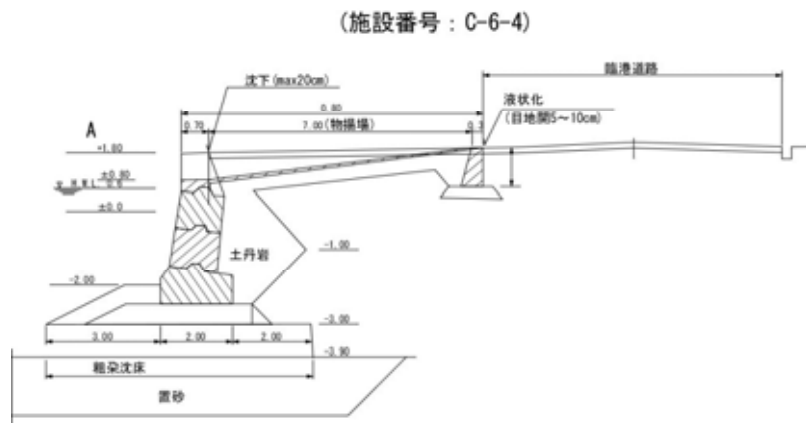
七尾港矢田新 物揚場 -2m 断面図
